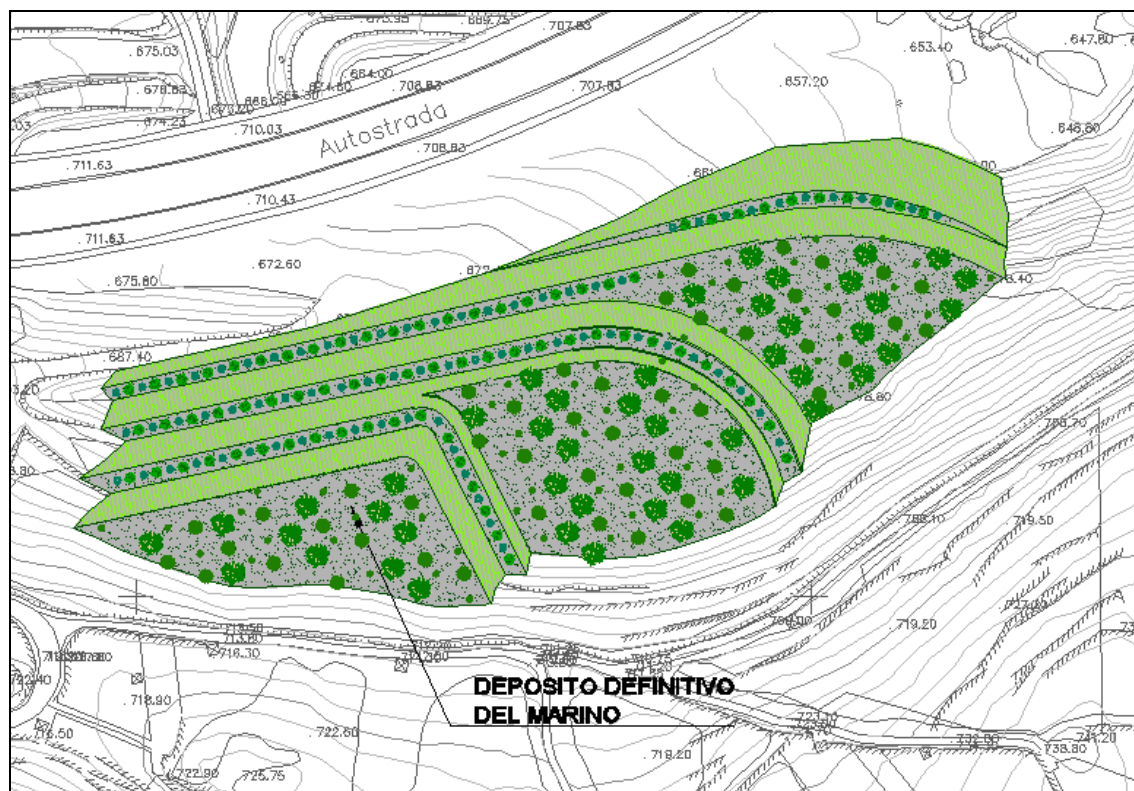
c: Sistemazione dell'area deponia di progetto definitivo – sezione B-B
